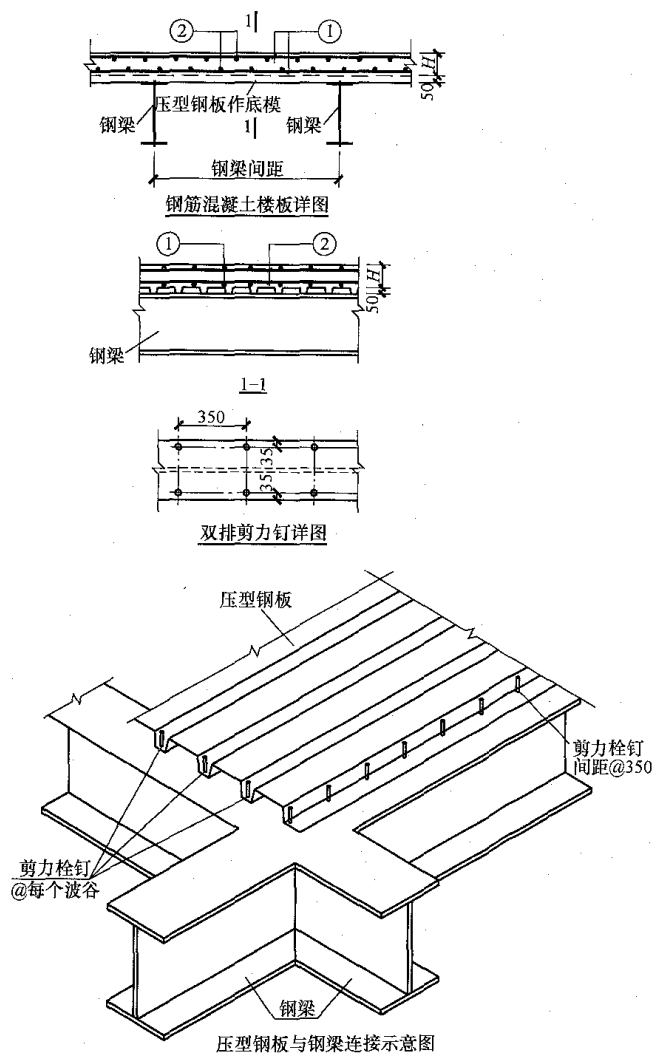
带压型钢板底模现浇钢筋混凝土屋面板构造
